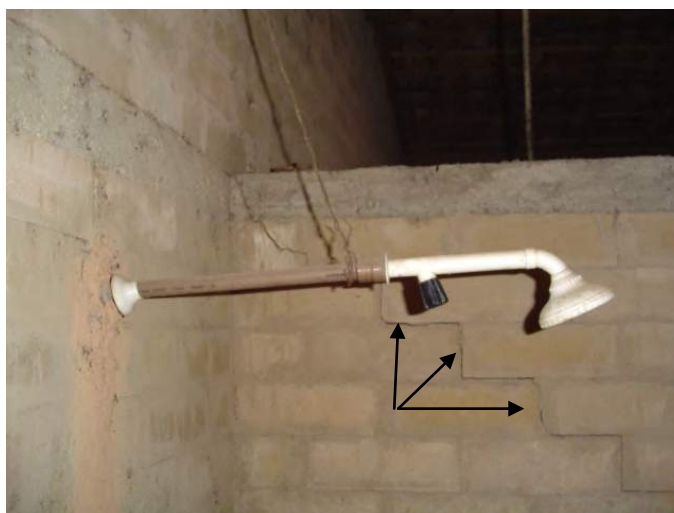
Fissura na junta da alvenaria em um banheiro
